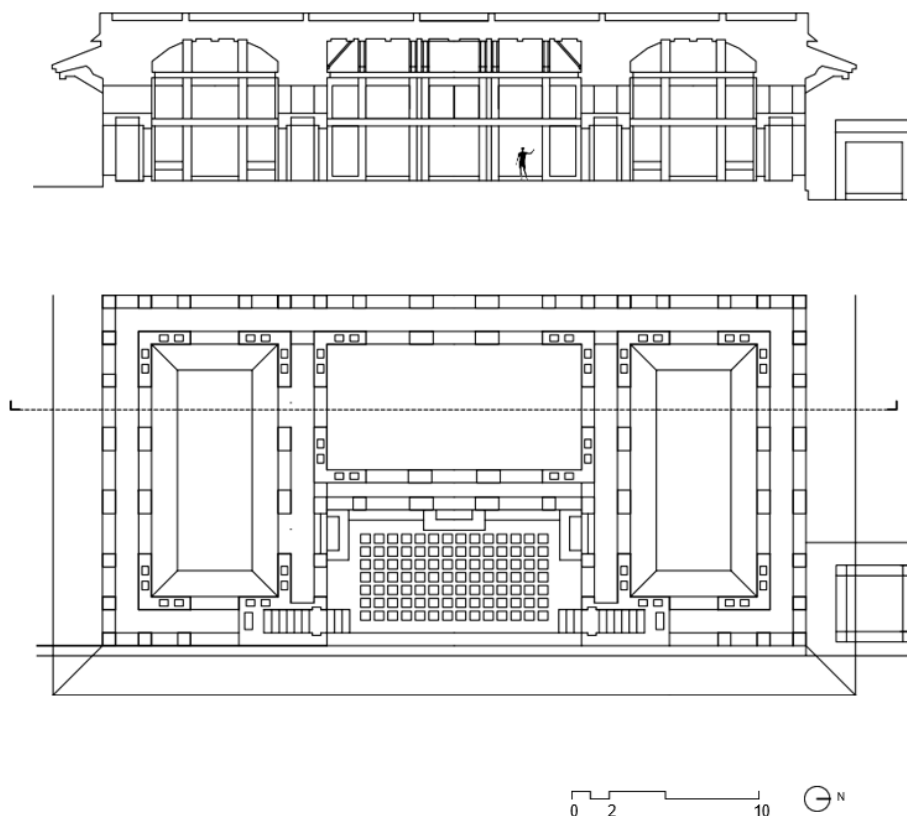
Planta y sección del Ankh Michauli. Dibujado por los autores del artículo con medidas tomadas in situ.
